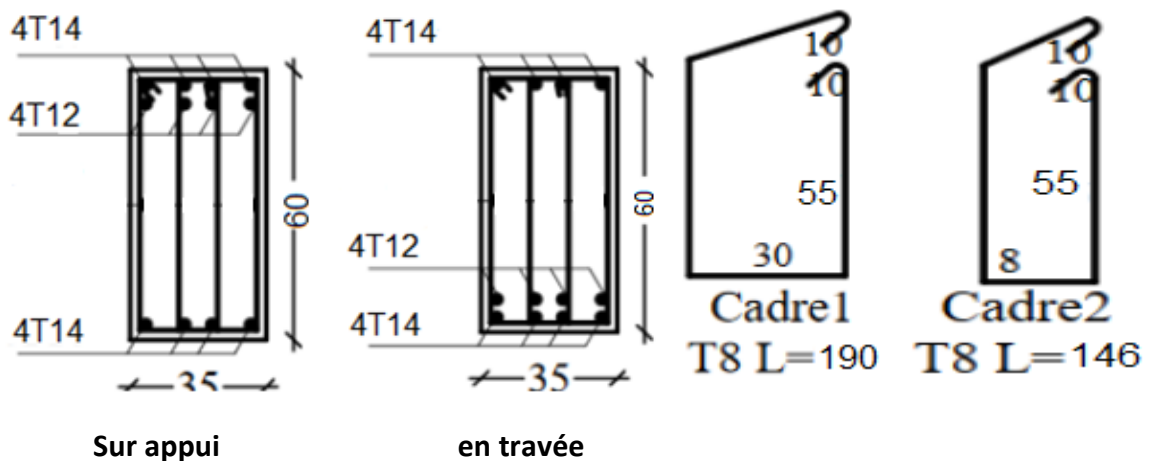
schéma de ferrailage poutre de libage bloc B
